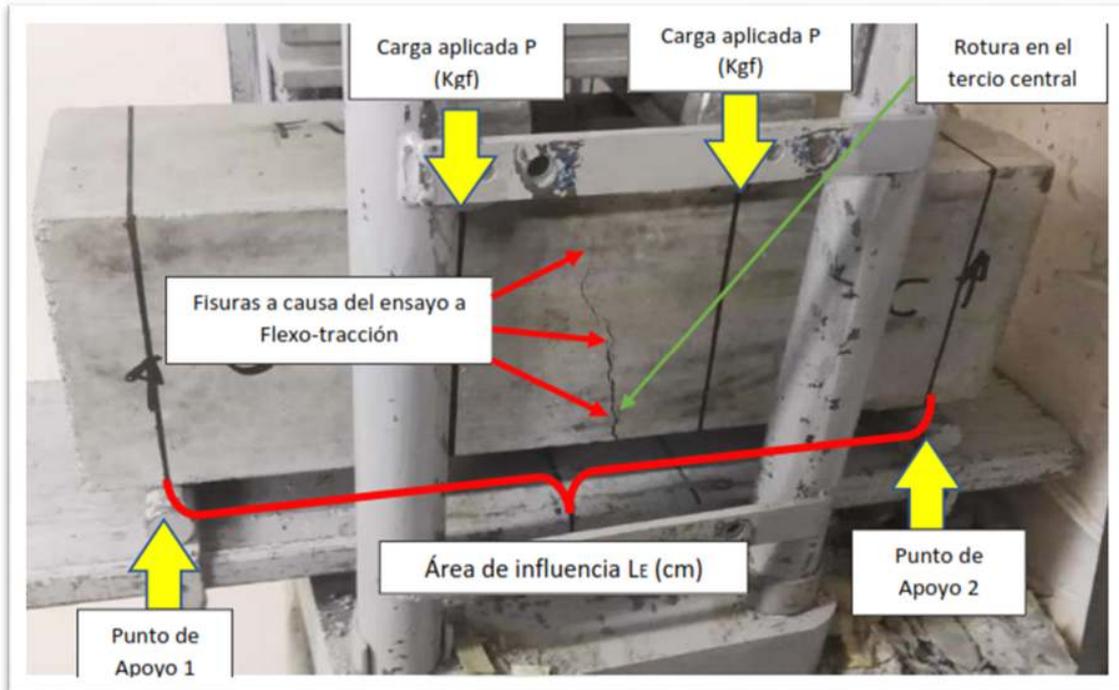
Viga ensayada a flexo-tracción. (Fuente: Elaboración Propia)
